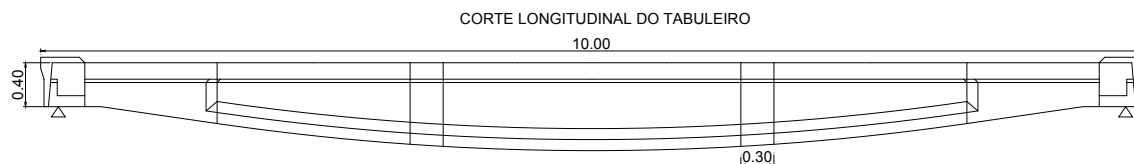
Corte longitudinal do tabuleiro pelo meio vão da carlinga.
